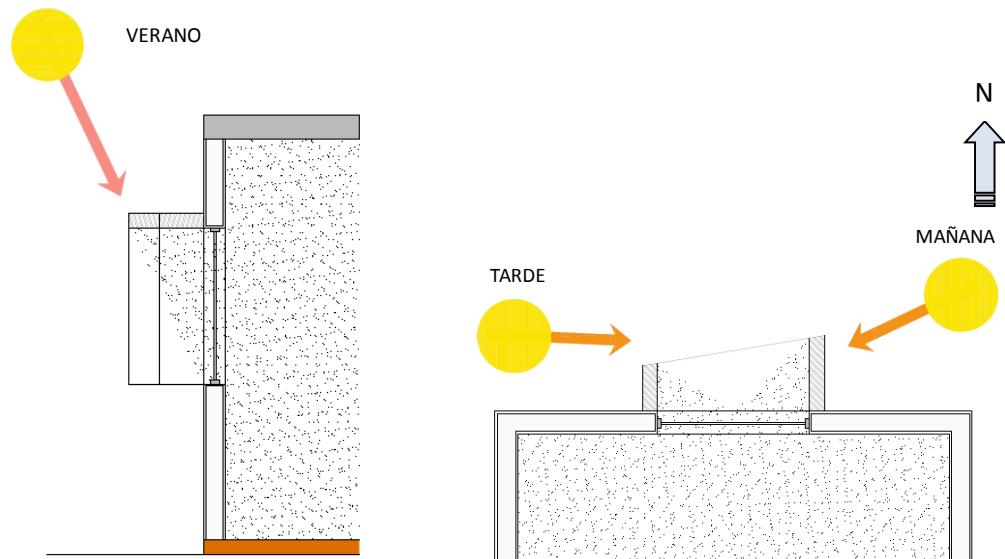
Elemento de protección solar para ventanas norte, corte y planta
